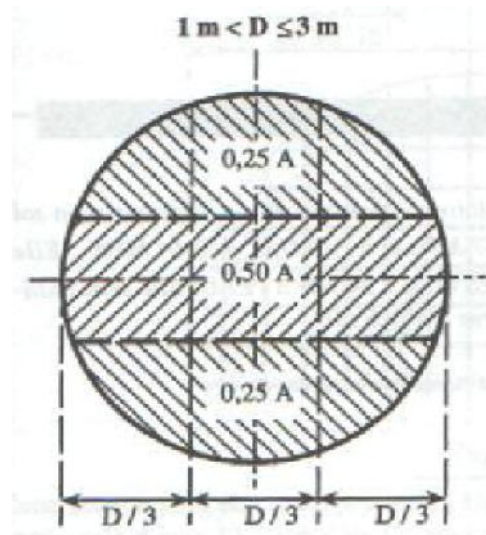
La disposition des armatures dans la semelle circulaire.
